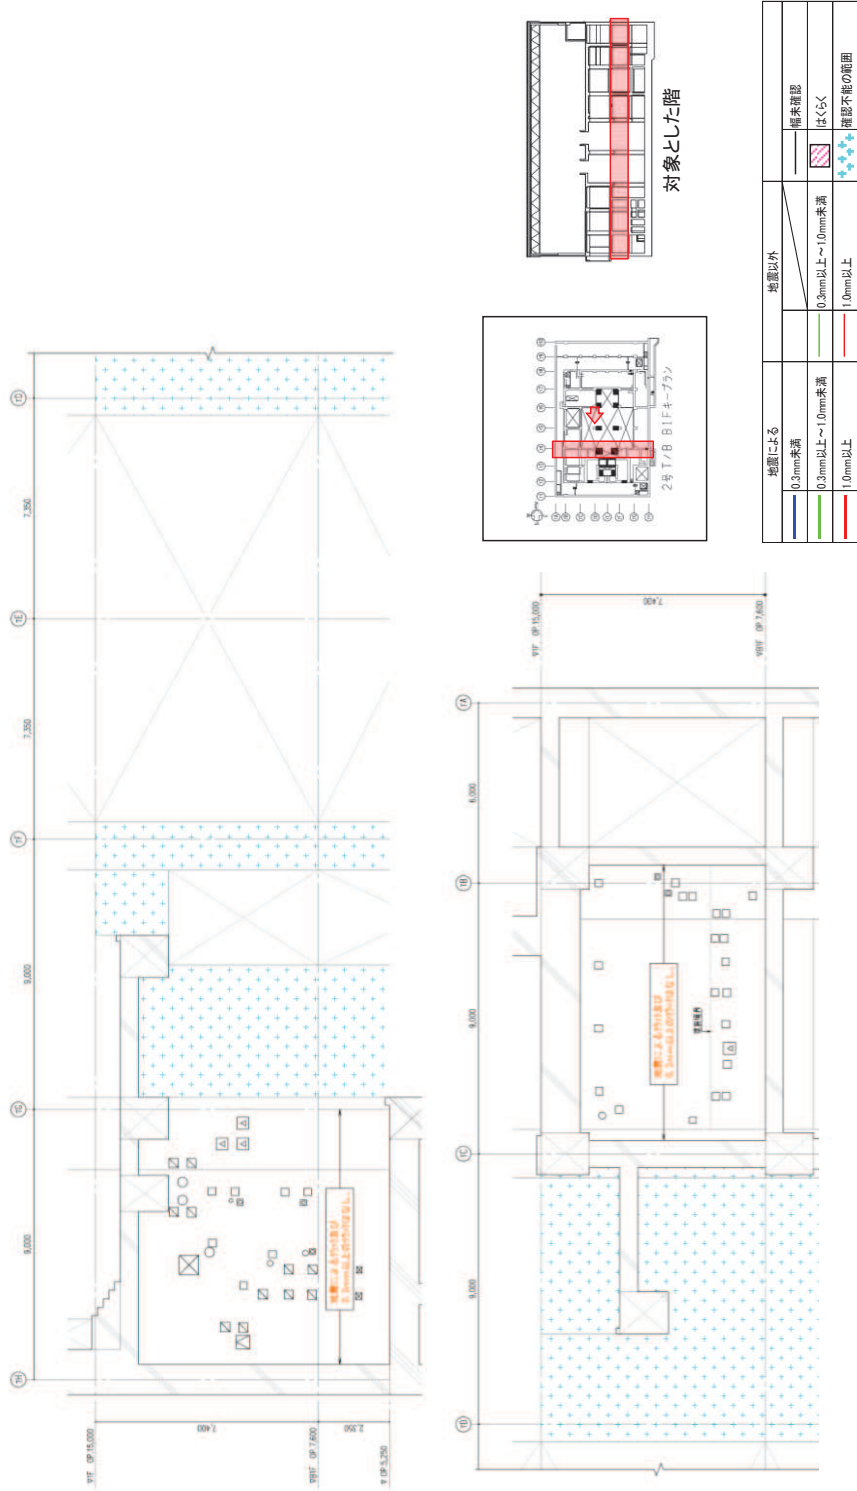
タービン建屋のひび割れ分布 耐震壁 (20) 地下 1 階 T4 通り
